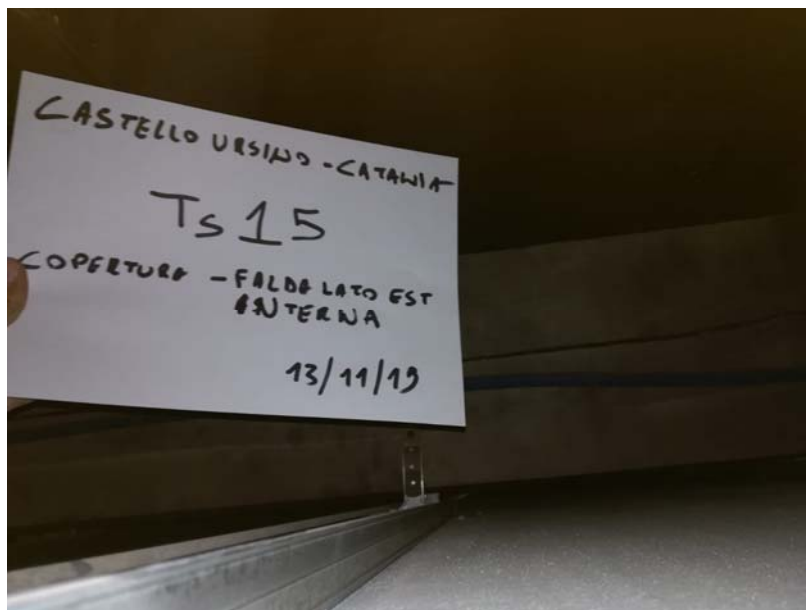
Traccia edile su copertura - Falda Lato Est Interna
